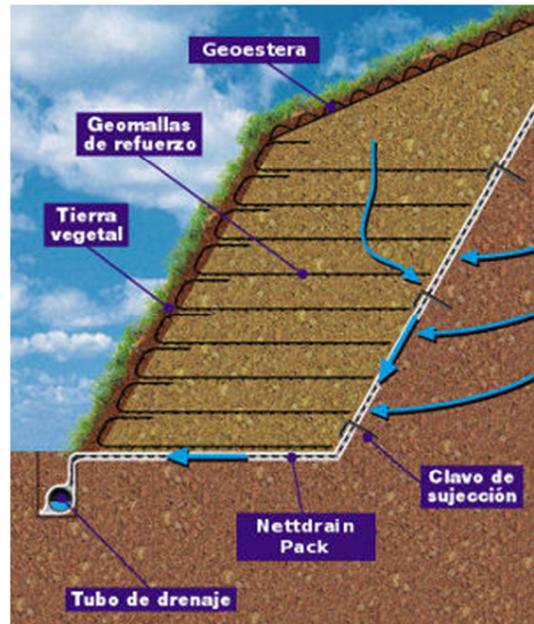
Detalle de instalación del sistema de muros verdes.
